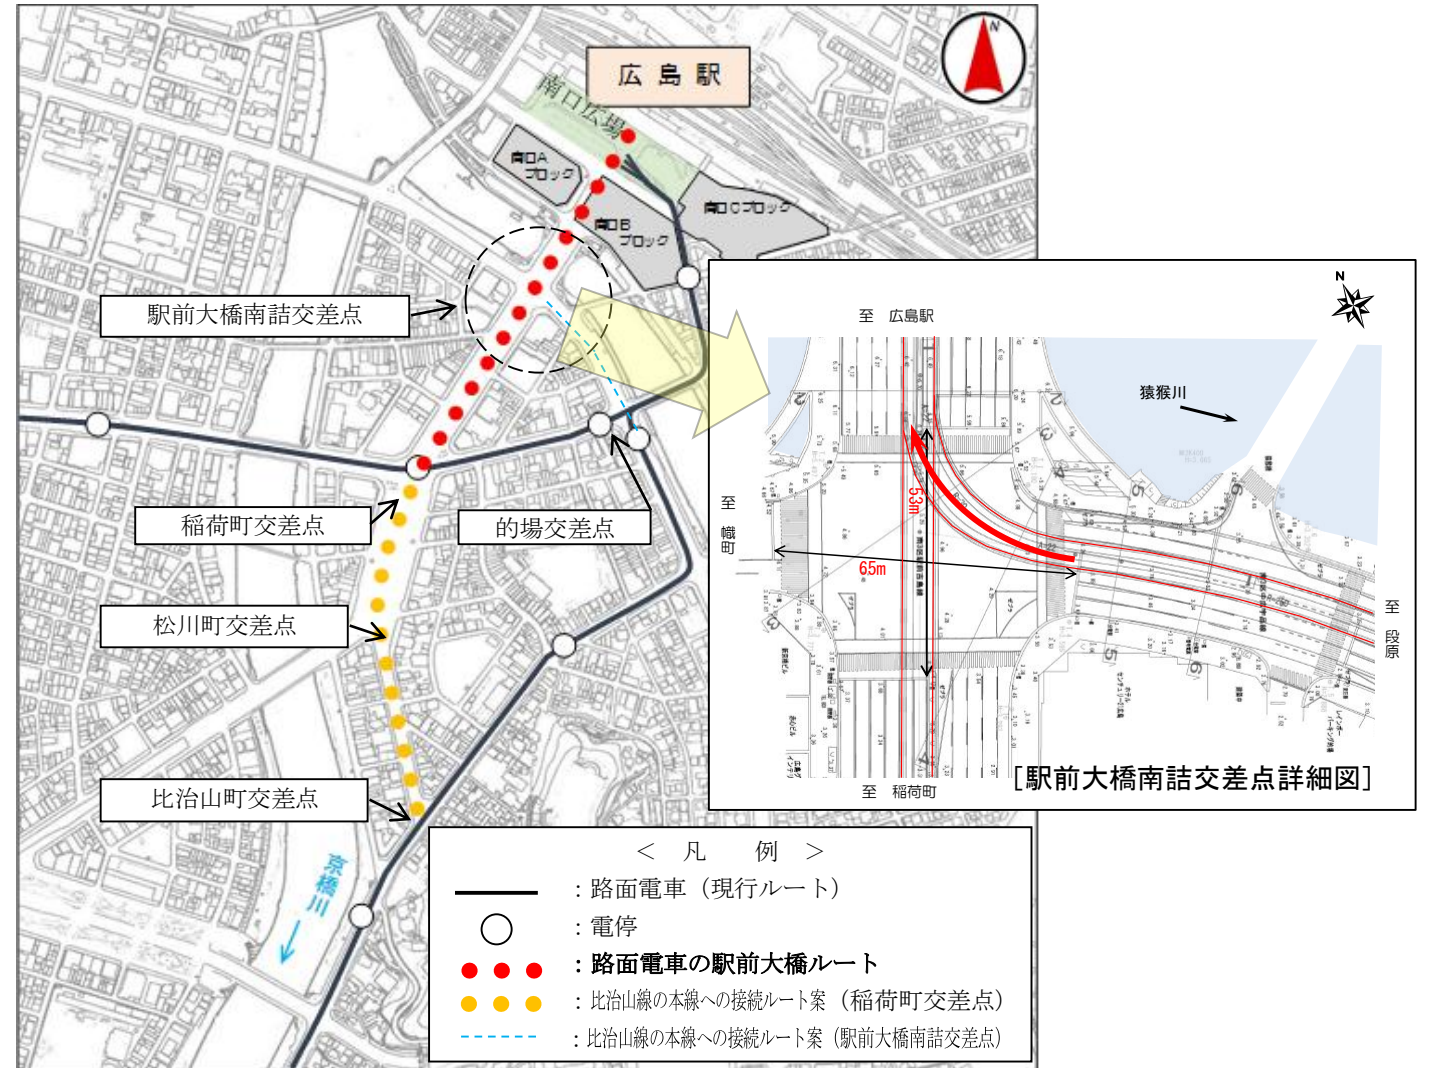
駅前大橋ルートと比治山線の接続ルート平面図
